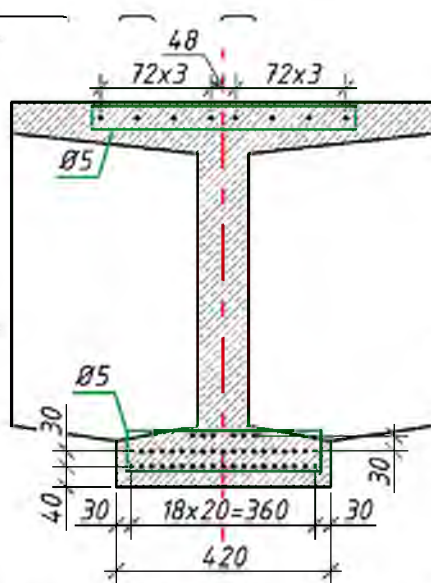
Схема розташування струн робочої арматури балки
